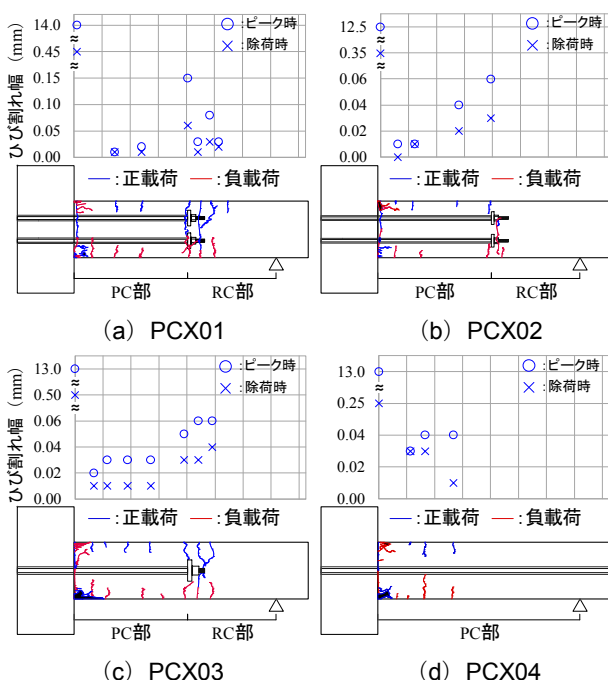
目開き及びひび割れ発生状況 (載荷終了時)
